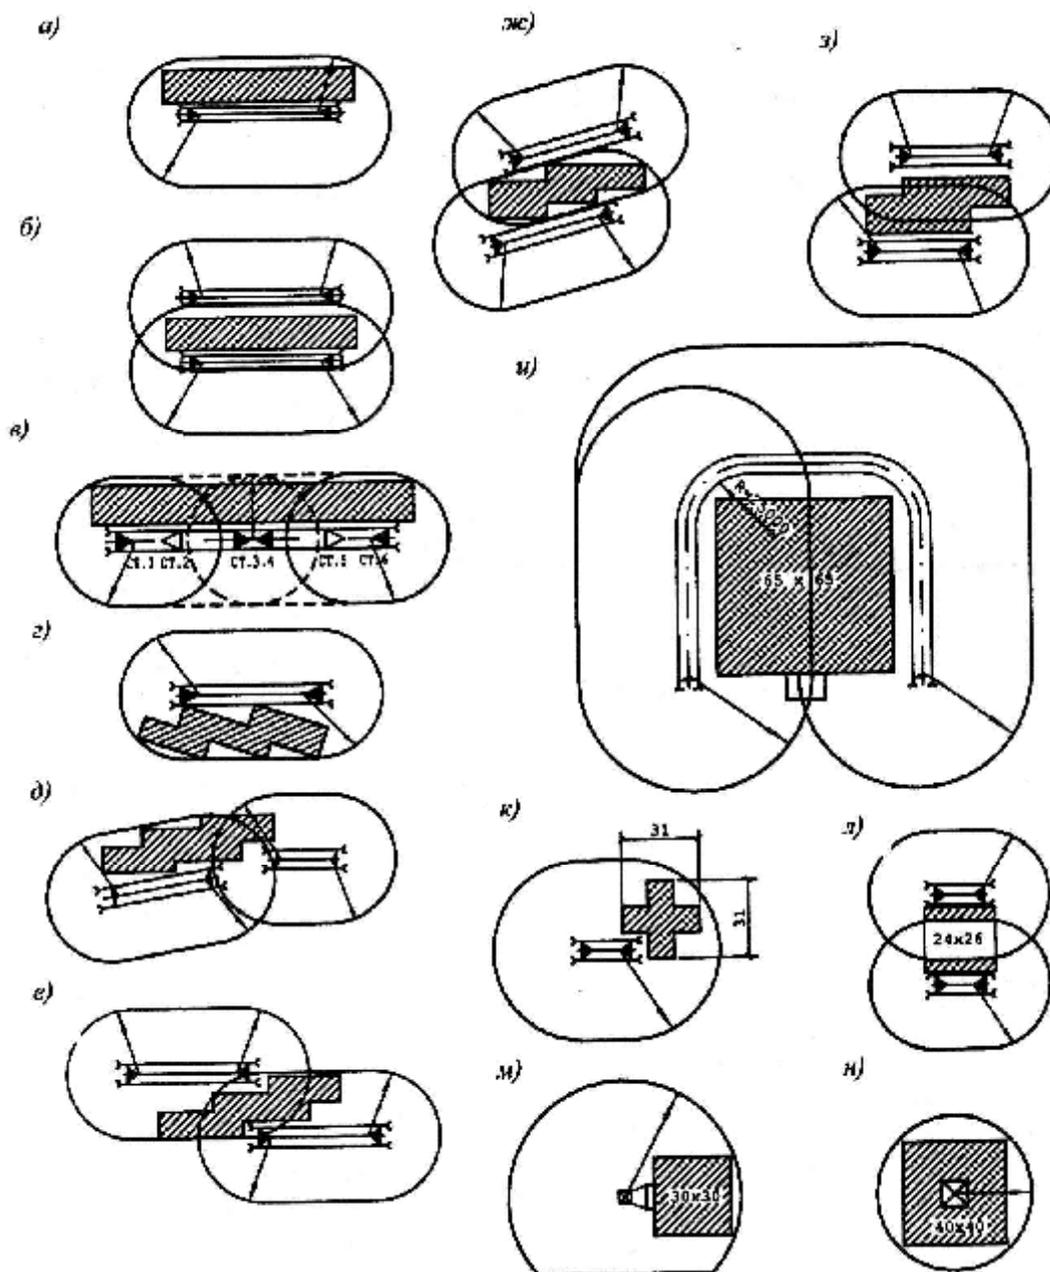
Схемы привязки монтажных кранов при возведении зданий жилищно-гражданского назначения: *а* – при строительстве протяжённых зданий, прямоугольных в плане (1 кран с одной стороны); *б* – при строительстве протяжённых зданий, прямоугольных в плане (2 крана с двух сторон); *в* – при установке двух кранов на общих путях; *г, д, е, ж, з* – при строительстве зданий ступенчатой формы в плане (краны с одной и двух сторон); *и* – при строительстве зданий больших габаритов (1 кран с трёх сторон); *к* – при строительстве зданий башенного типа (1 кран с одной стороны); *л* – при строительстве зданий башенного типа (2 крана с двух сторон); *м* – при строительстве зданий башенного типа приставным краном; *н* – при строительстве зданий башенного типа самоподъёмным или переставным краном
